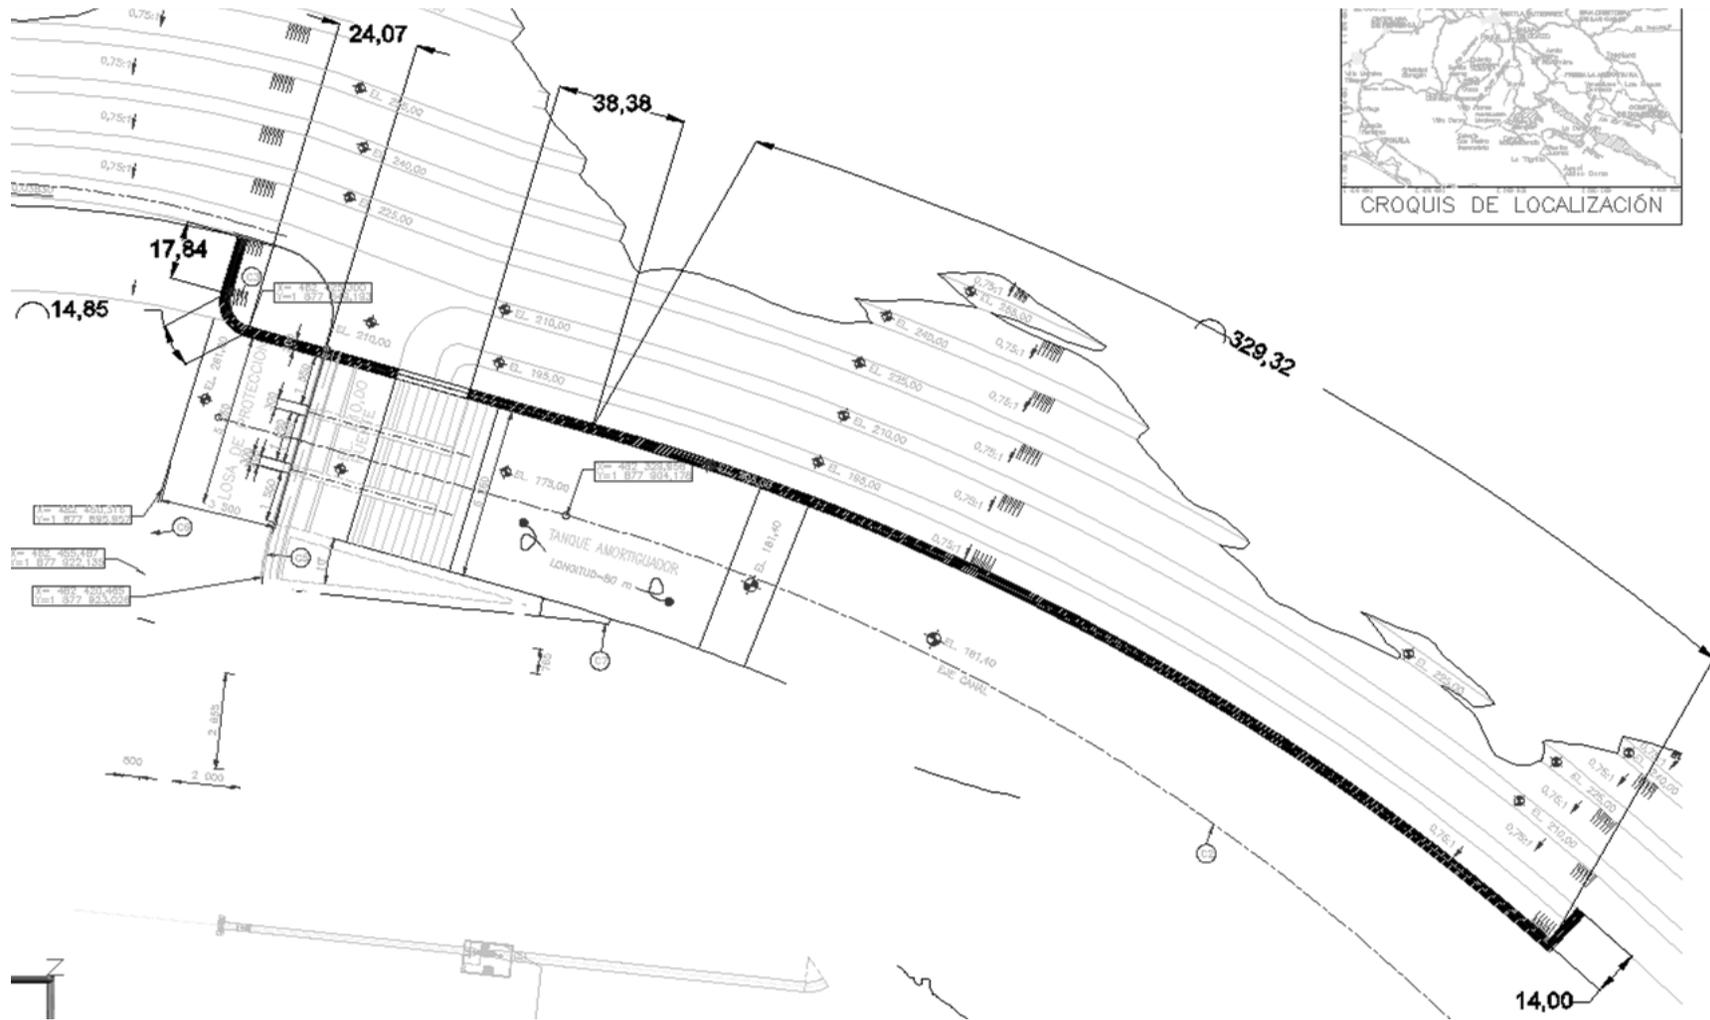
Planta de Muro Lateral de Encausamiento de Margen Izquierda
